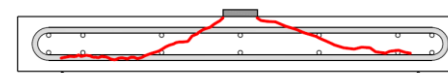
供試体切断面の載荷ひび割れ状況 (供試体 F)
